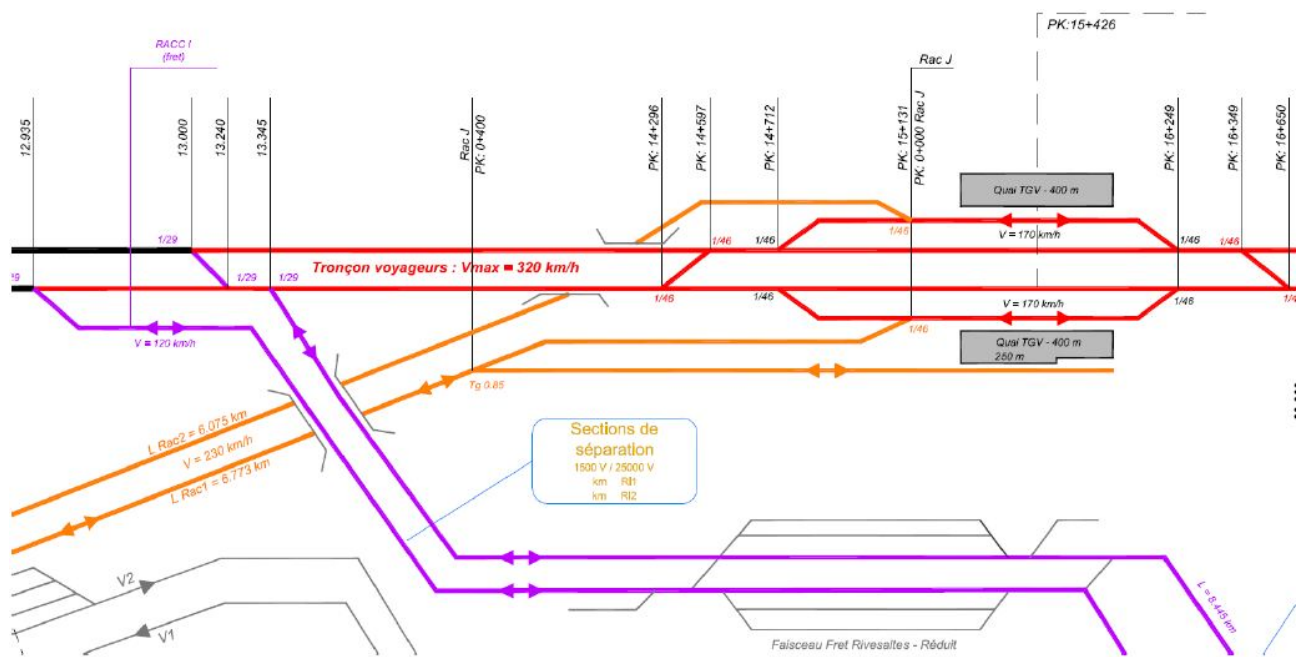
Secteur Camp Joffre - Schéma installation ferroviaire avec gare
